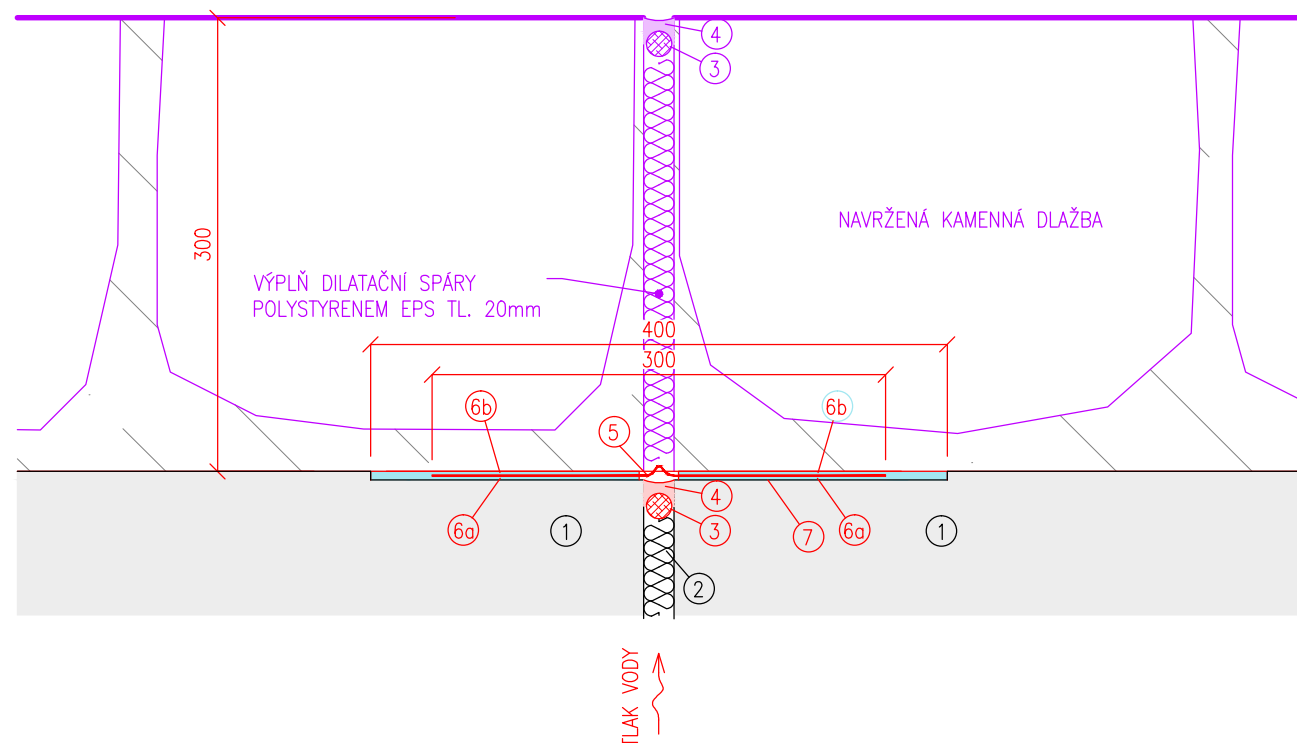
PŮDORYSNÝ ŘEZ DODATEČNĚ
